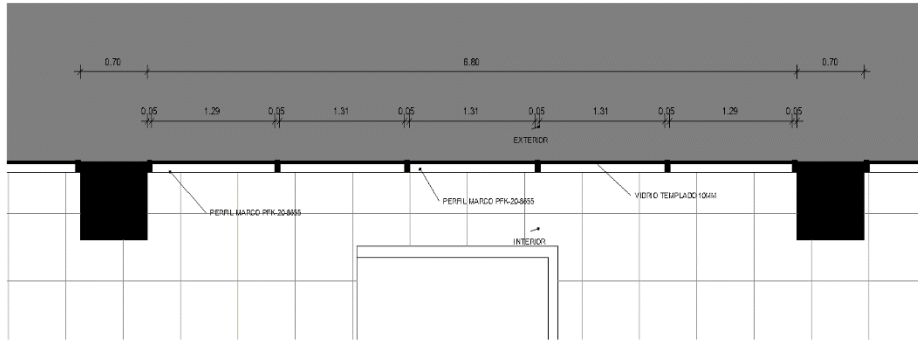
Detalle en planta de quiebravistas. Fuente: elaboración propia
